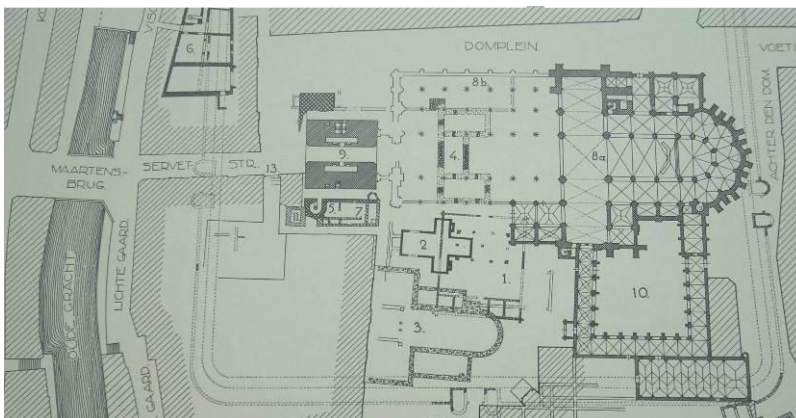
Grundriss der gotischen Domkirche mit der Heilig-Kreuz-Kapelle und Salvatorkirche im Süden
